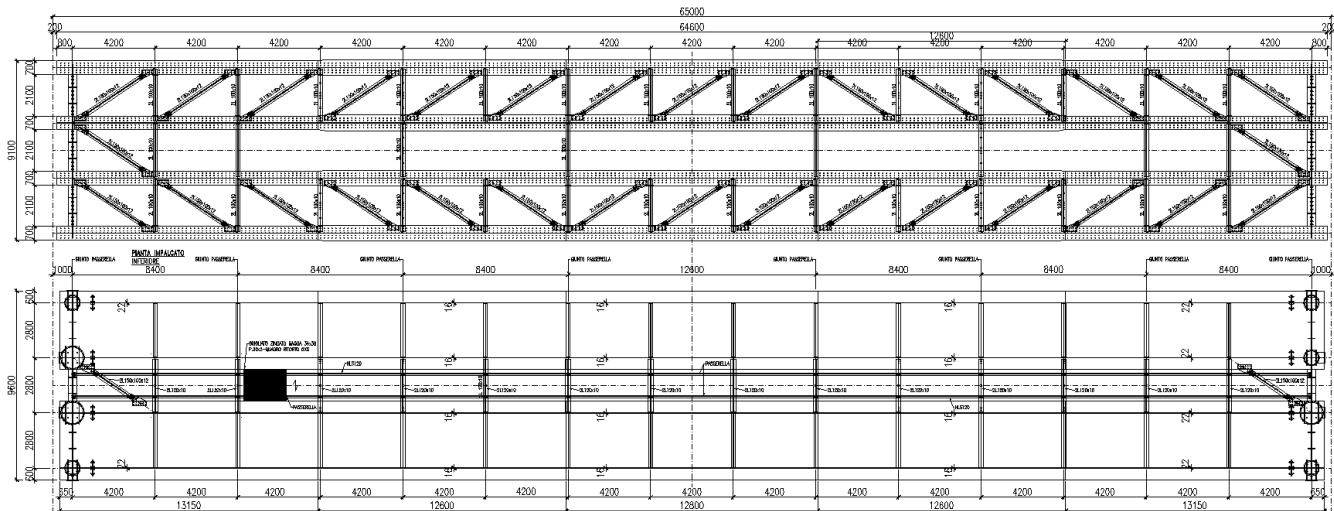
Pianta di impalcato (superiore ed inferiore)
